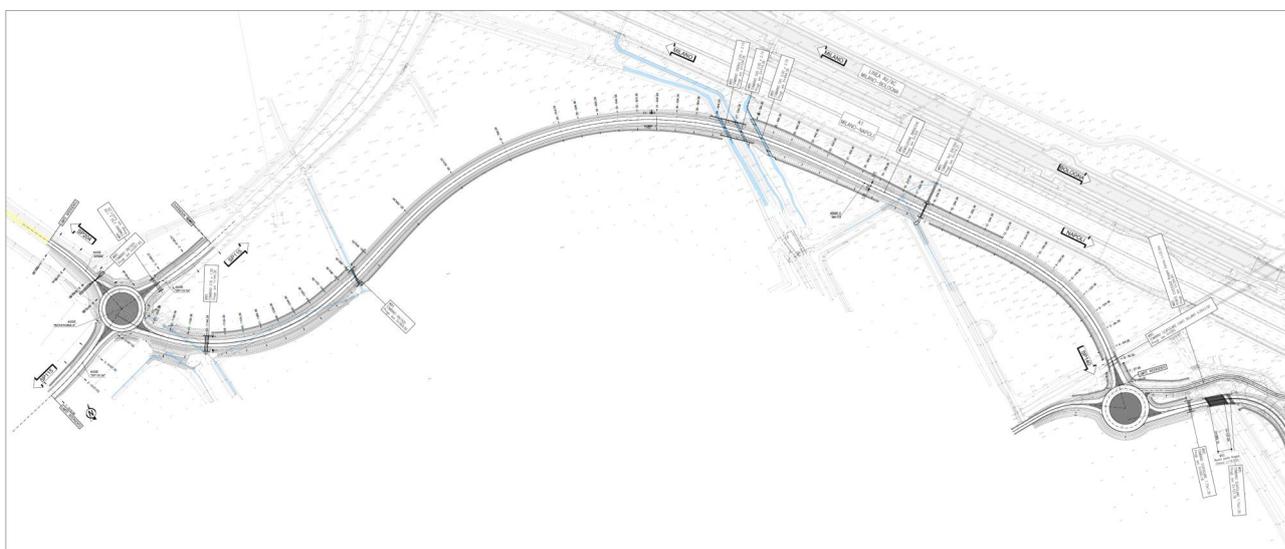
Stralcio planimetrico Nuovo collegamento SP140-SP115
